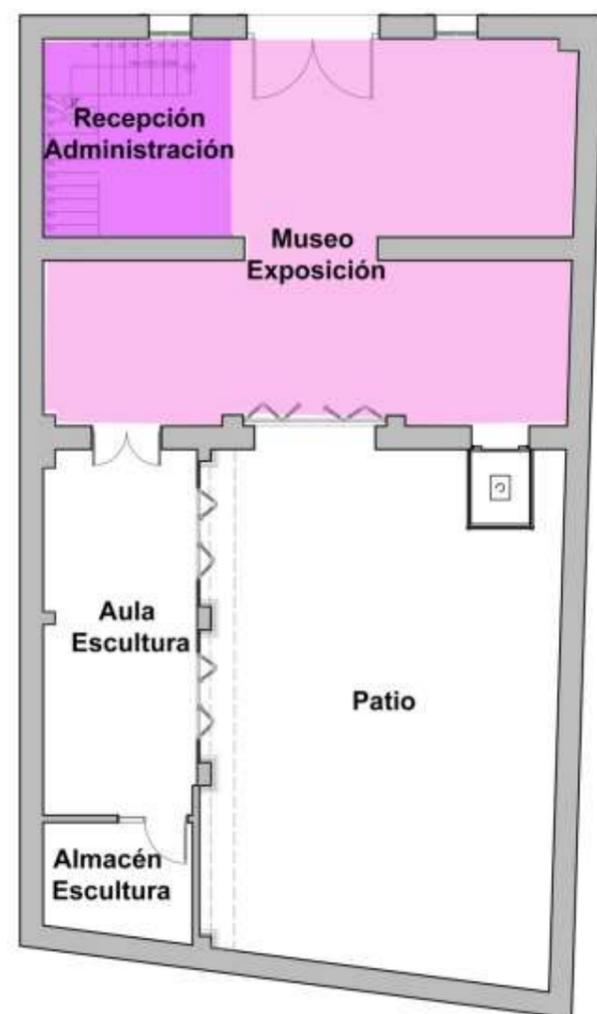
zonificación Planta Baja con el estado propuesto. Elaboración propia
